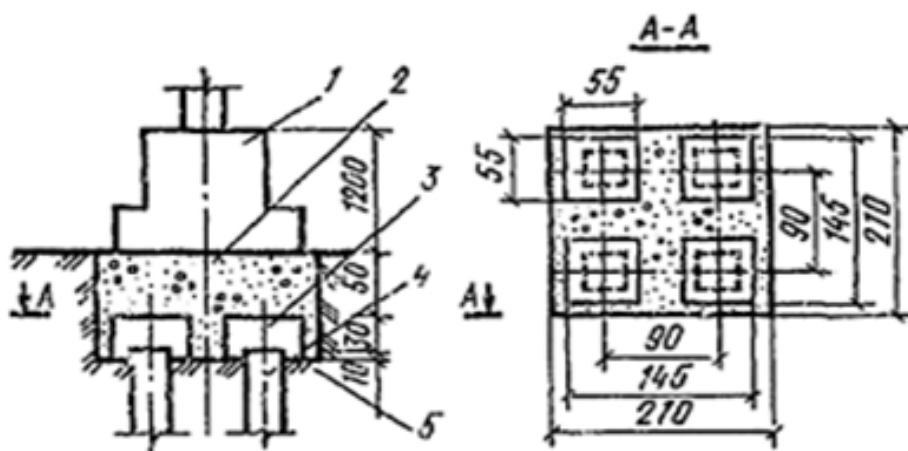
Свайный фундамент с промежуточной подушкой: 1 — фундаментный блок; 2 — промежуточная подушка; 3 — железобетонные оголовки; 4 — железобетонные сваи; 5 — поверхность дна котлована
